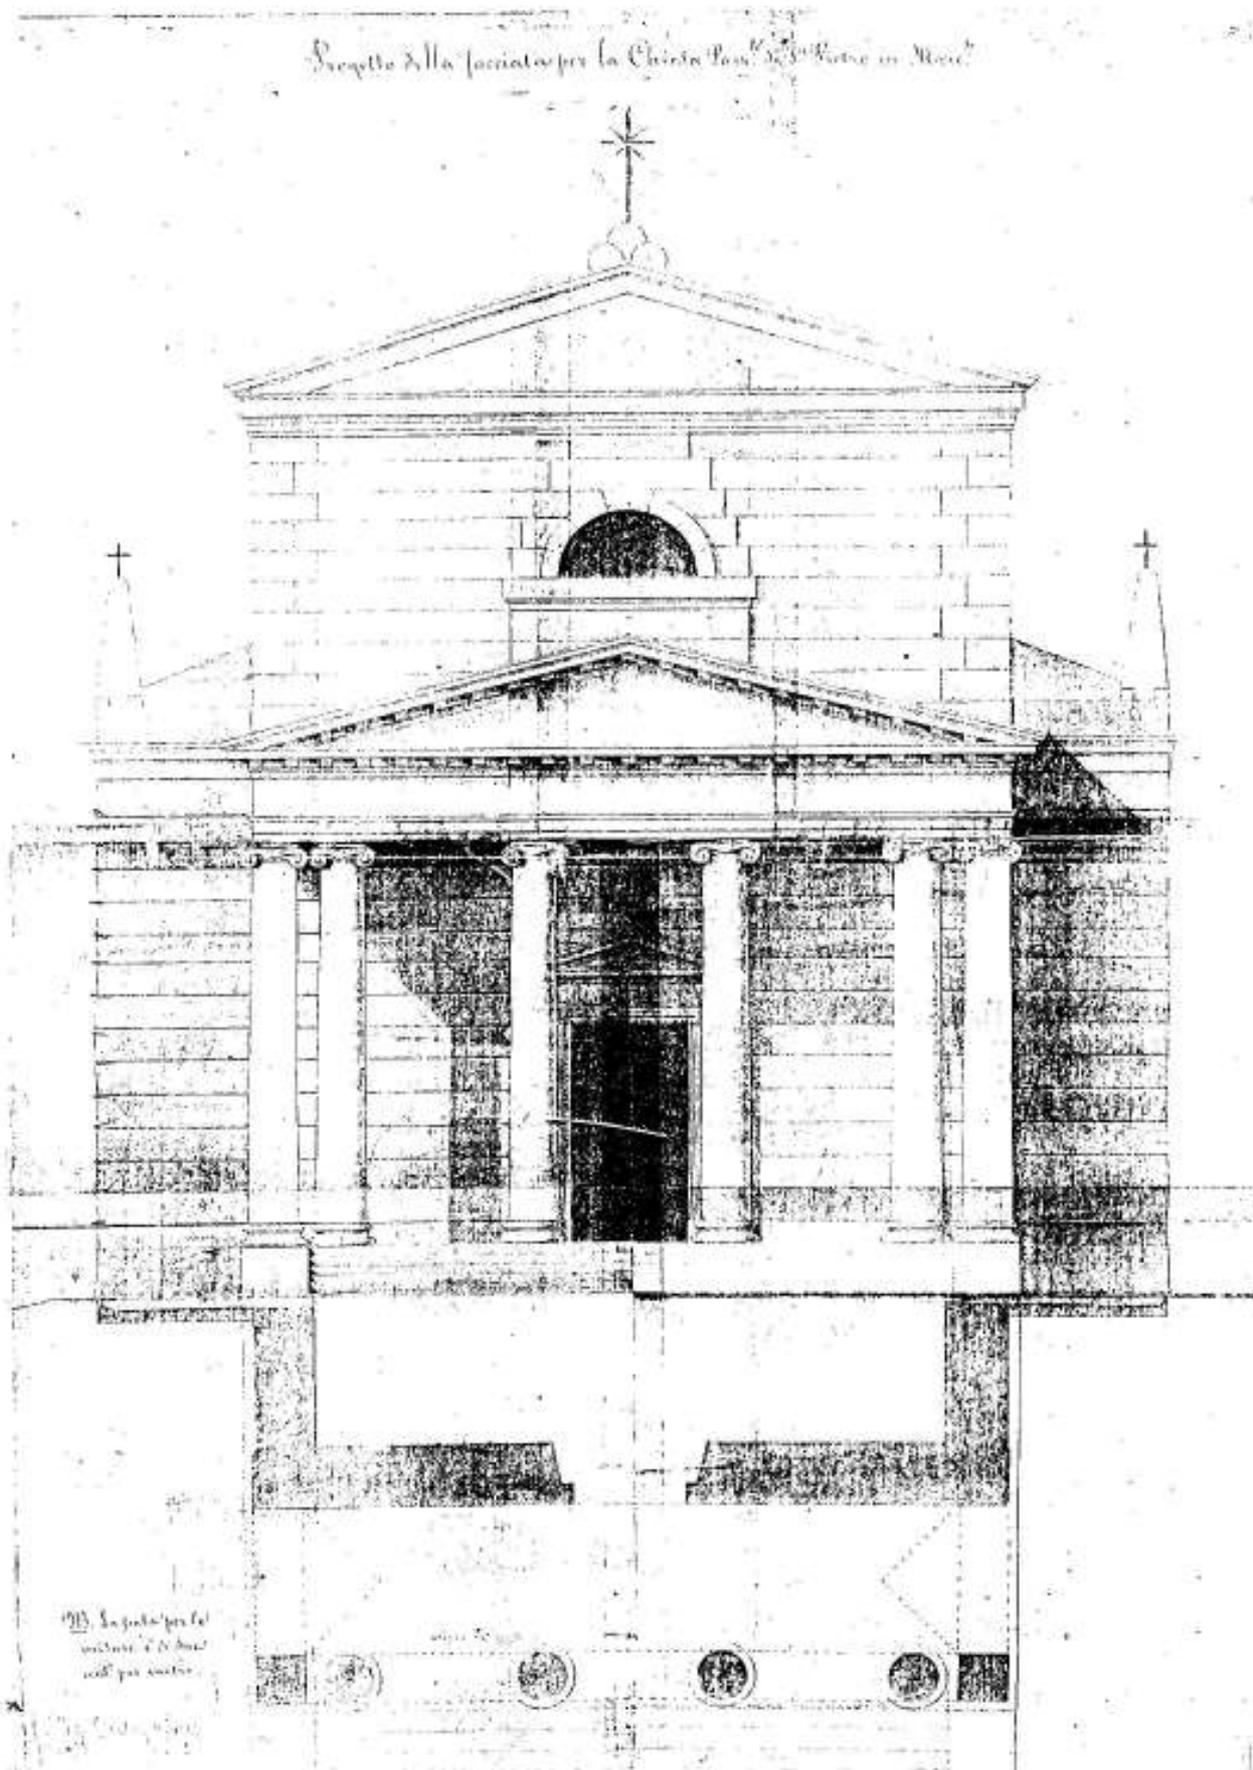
Progetto dell'ing. Guido Gaspari (1873): prospetto della facciata.
